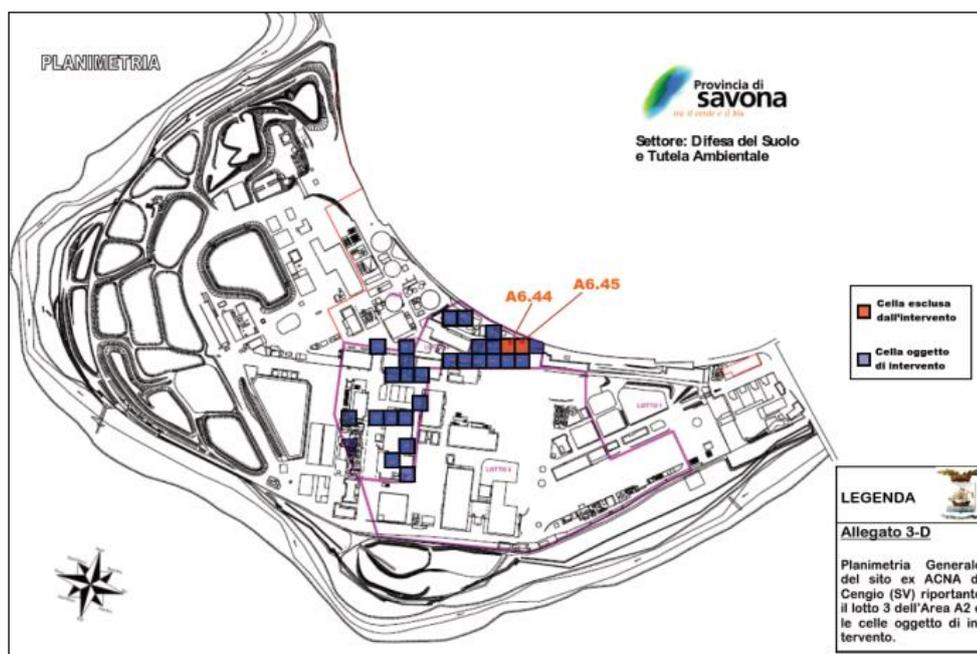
Planimetria Generale del sito ex ACNA di Cengio (SV) riportante il Lotto 3 dell'Area A2 e le celle oggetto di intervento
